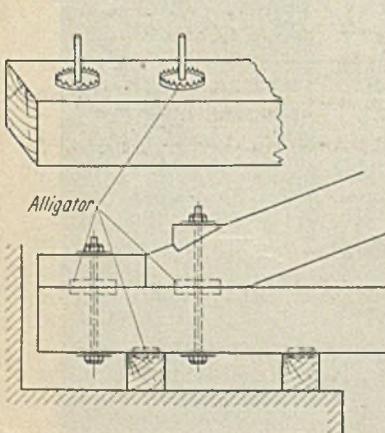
Holzverbindung mit „Alligator“-Dübeln.
